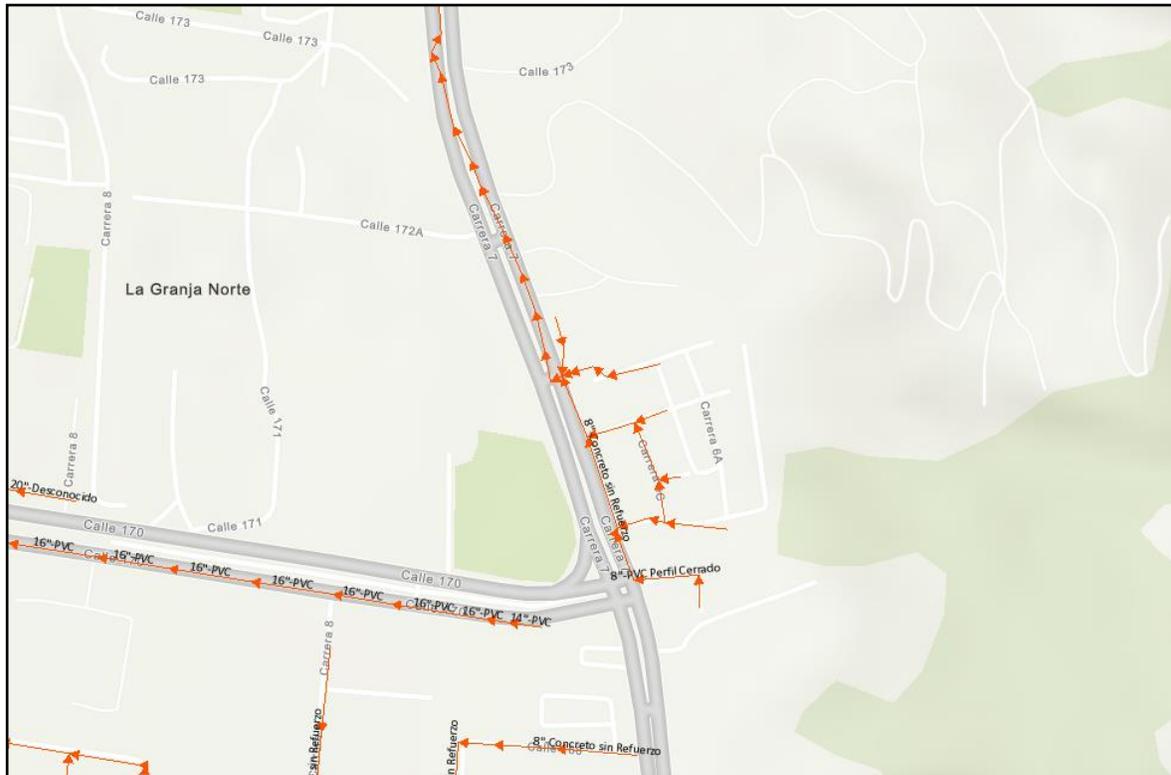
Sector Hidráulico Alcantarillado Sanitario.
